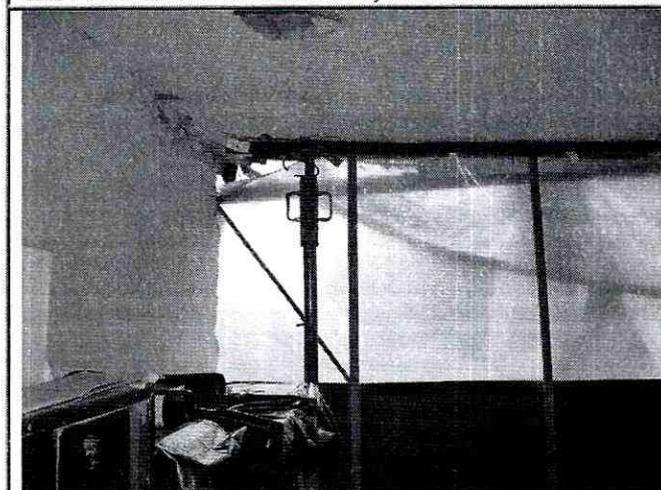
Muro de cerramiento del predio de la carrera 4 # 7-05 Sur ubicado costado nor-occidental que colapso y colinda con el predio de la calle 7 # 4-07 sur
